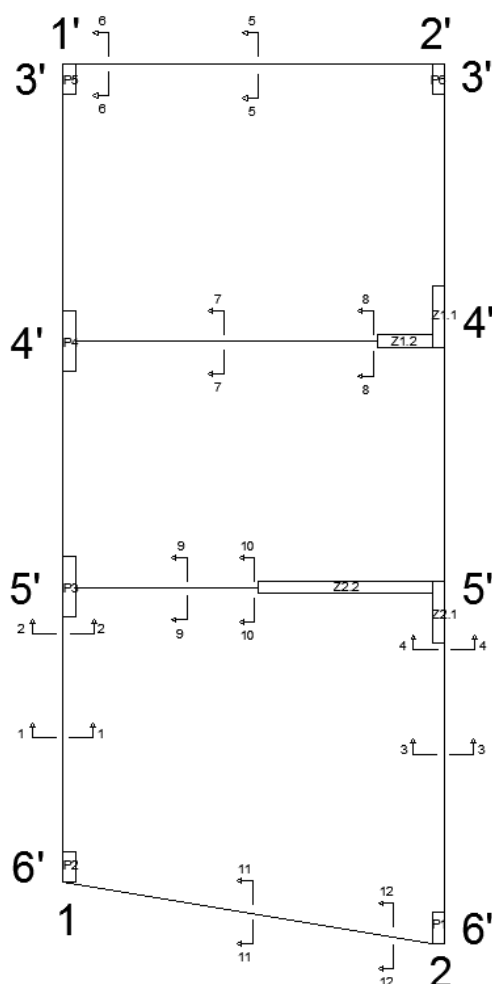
Representação das secções tipo dos elementos estruturais em planta
